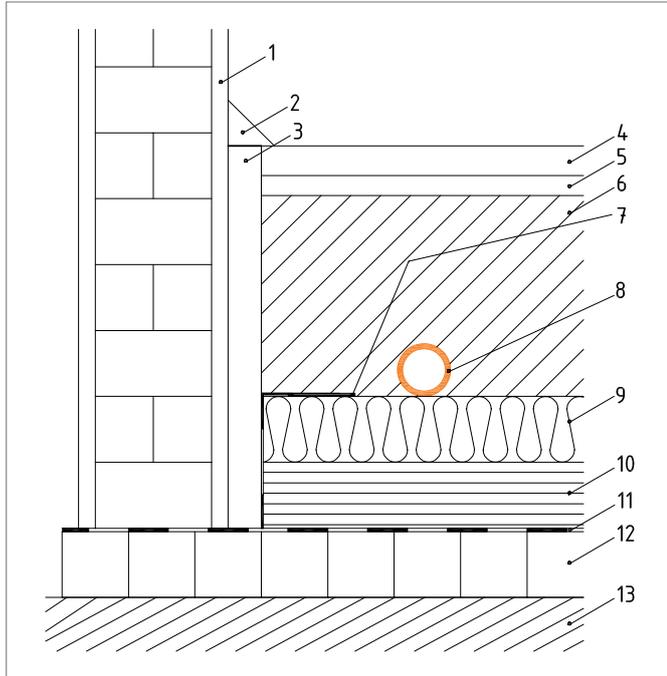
Exemple de construction d'un système chauffage / refroidissement par le sol en construction humide
